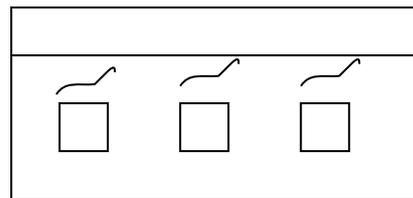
Чрезмерные нагрузки на перекрытия – прогиб балки перекрытия
